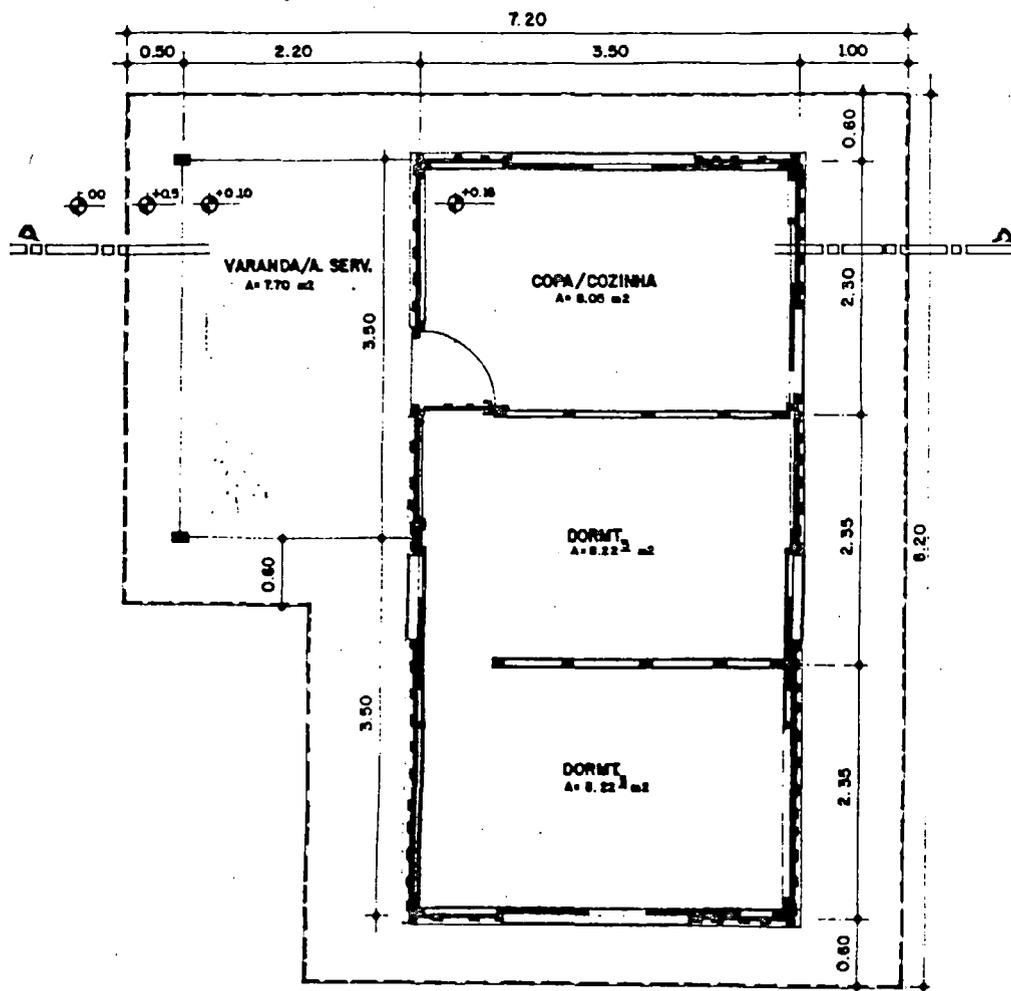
Planta baixa tipo com área construída de 32,20 m²
